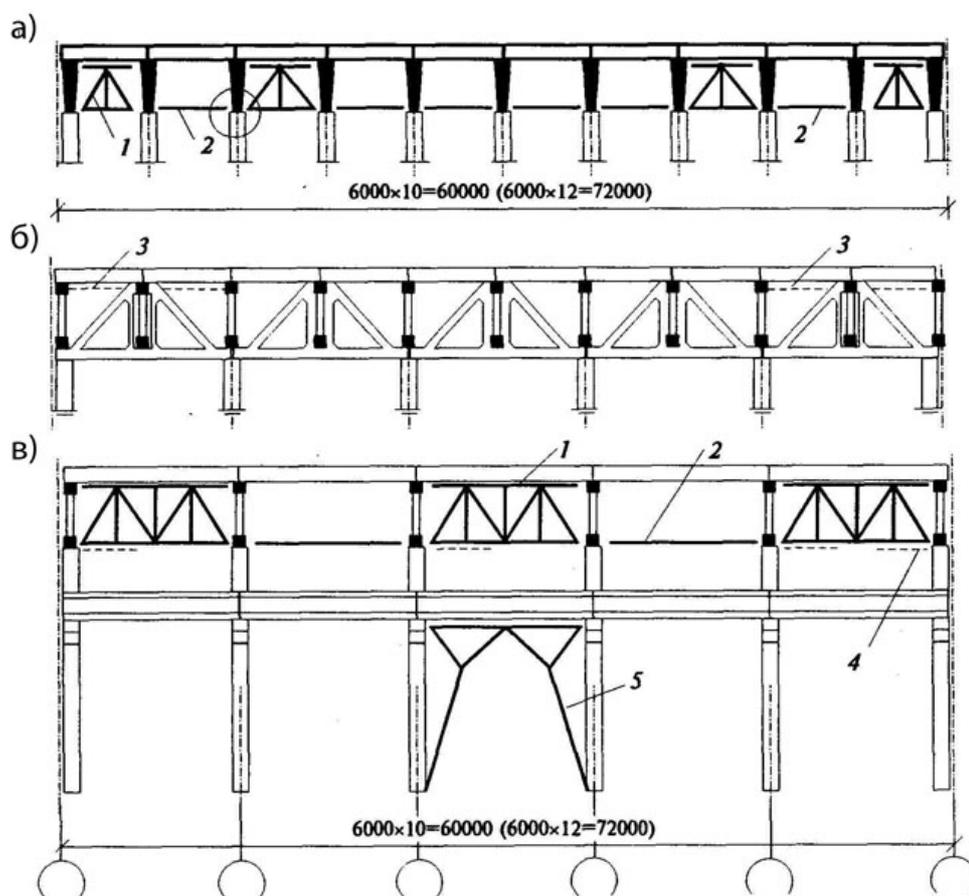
Связи в покрытиях при железобетонных стропильных конструкциях: а) при шаге 6 м в бескрановых зданиях без подстропильных конструкций; б) то же, с подстропильными конструкциями; в) при шаге 12 м в зданиях с мостовыми кранами; 1 – вертикальная связь по фермам; 2 – распорка; 3 – горизонтальная распорка по подстропильным фермам; 4 – горизонтальная ферма в торцах; 5 – связь по колоннам
